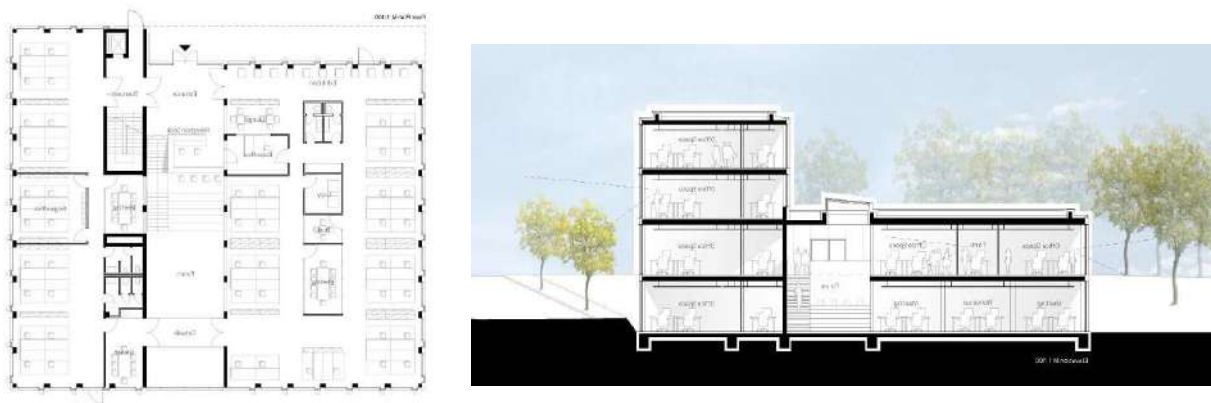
а) – план першого поверху; б) – розріз будівлі. [43]
